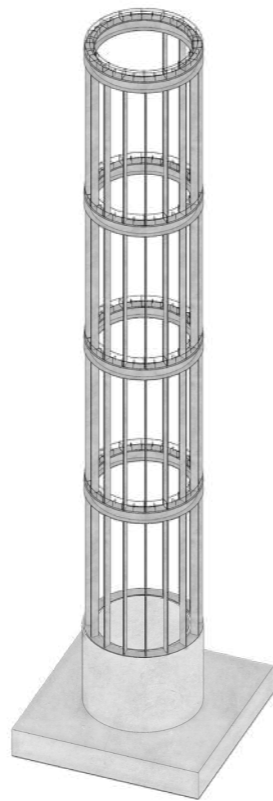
,37: Axonometría núcleo 2,3 Fuente: elaboración propia
